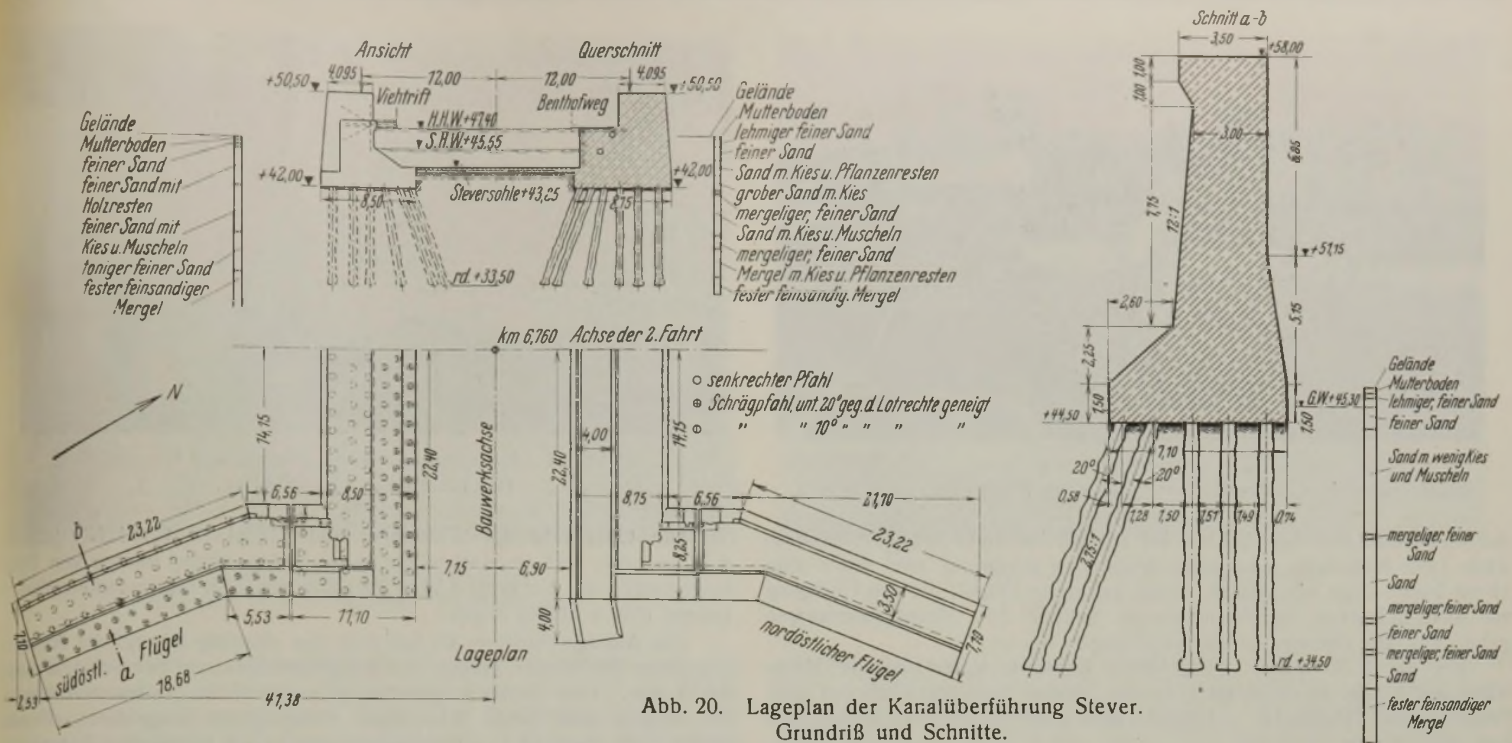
Lageplan der Kanalüberführung Stever. Grundriß und Schnitt.
